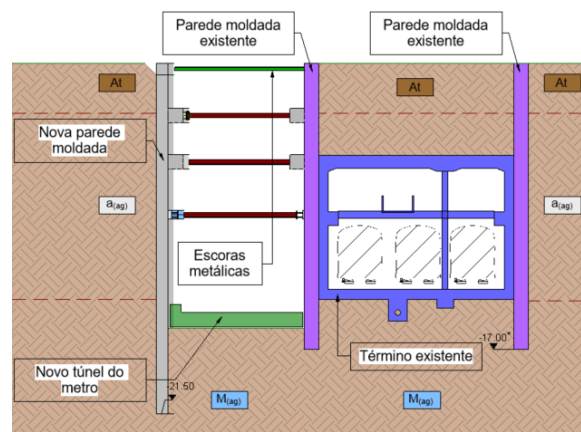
Secção: Solução de escavação *Cut&Cover*.
